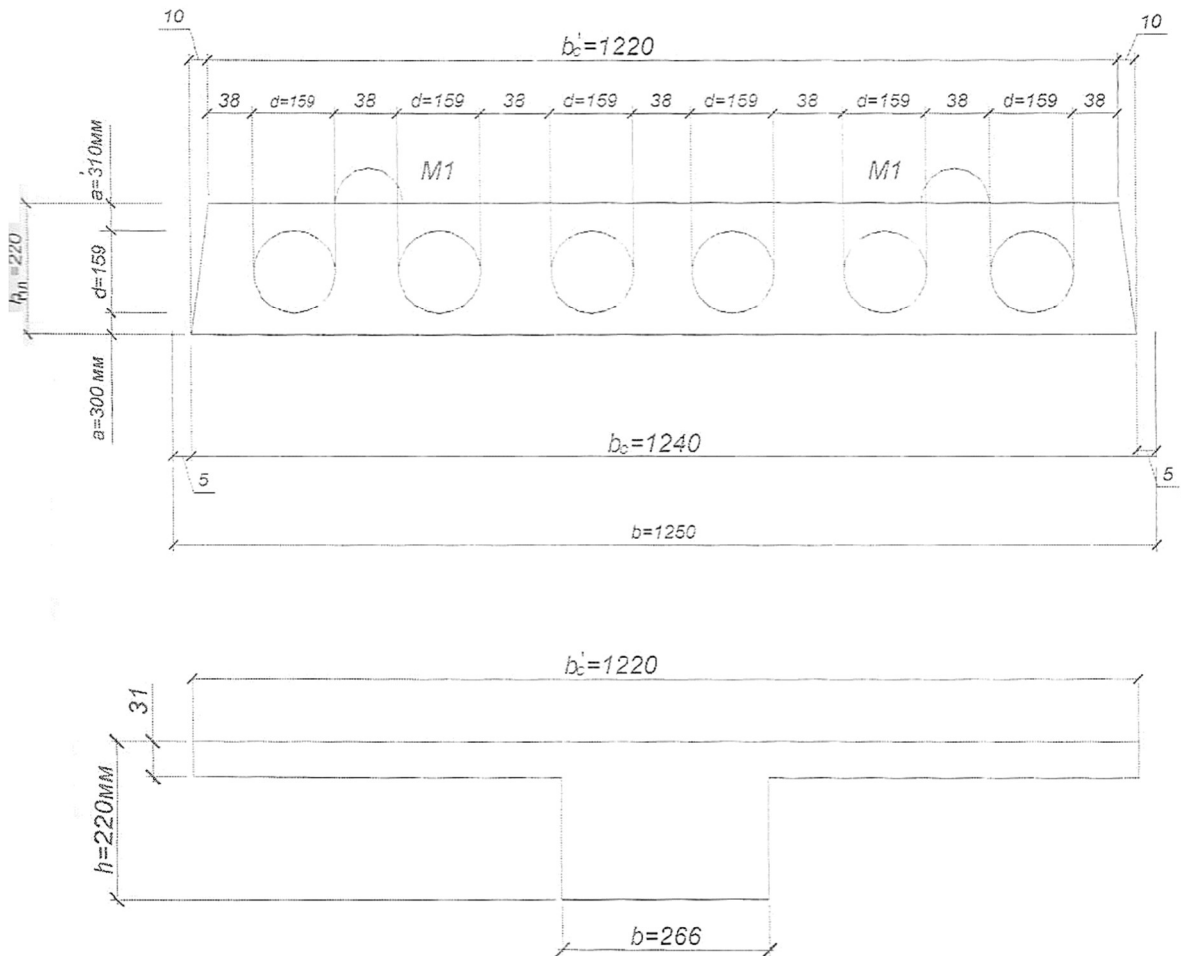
Дійсний (а) і розрахунковий (б) перерізи плити перекриття з овальними порожнинами шириною 1,25м
